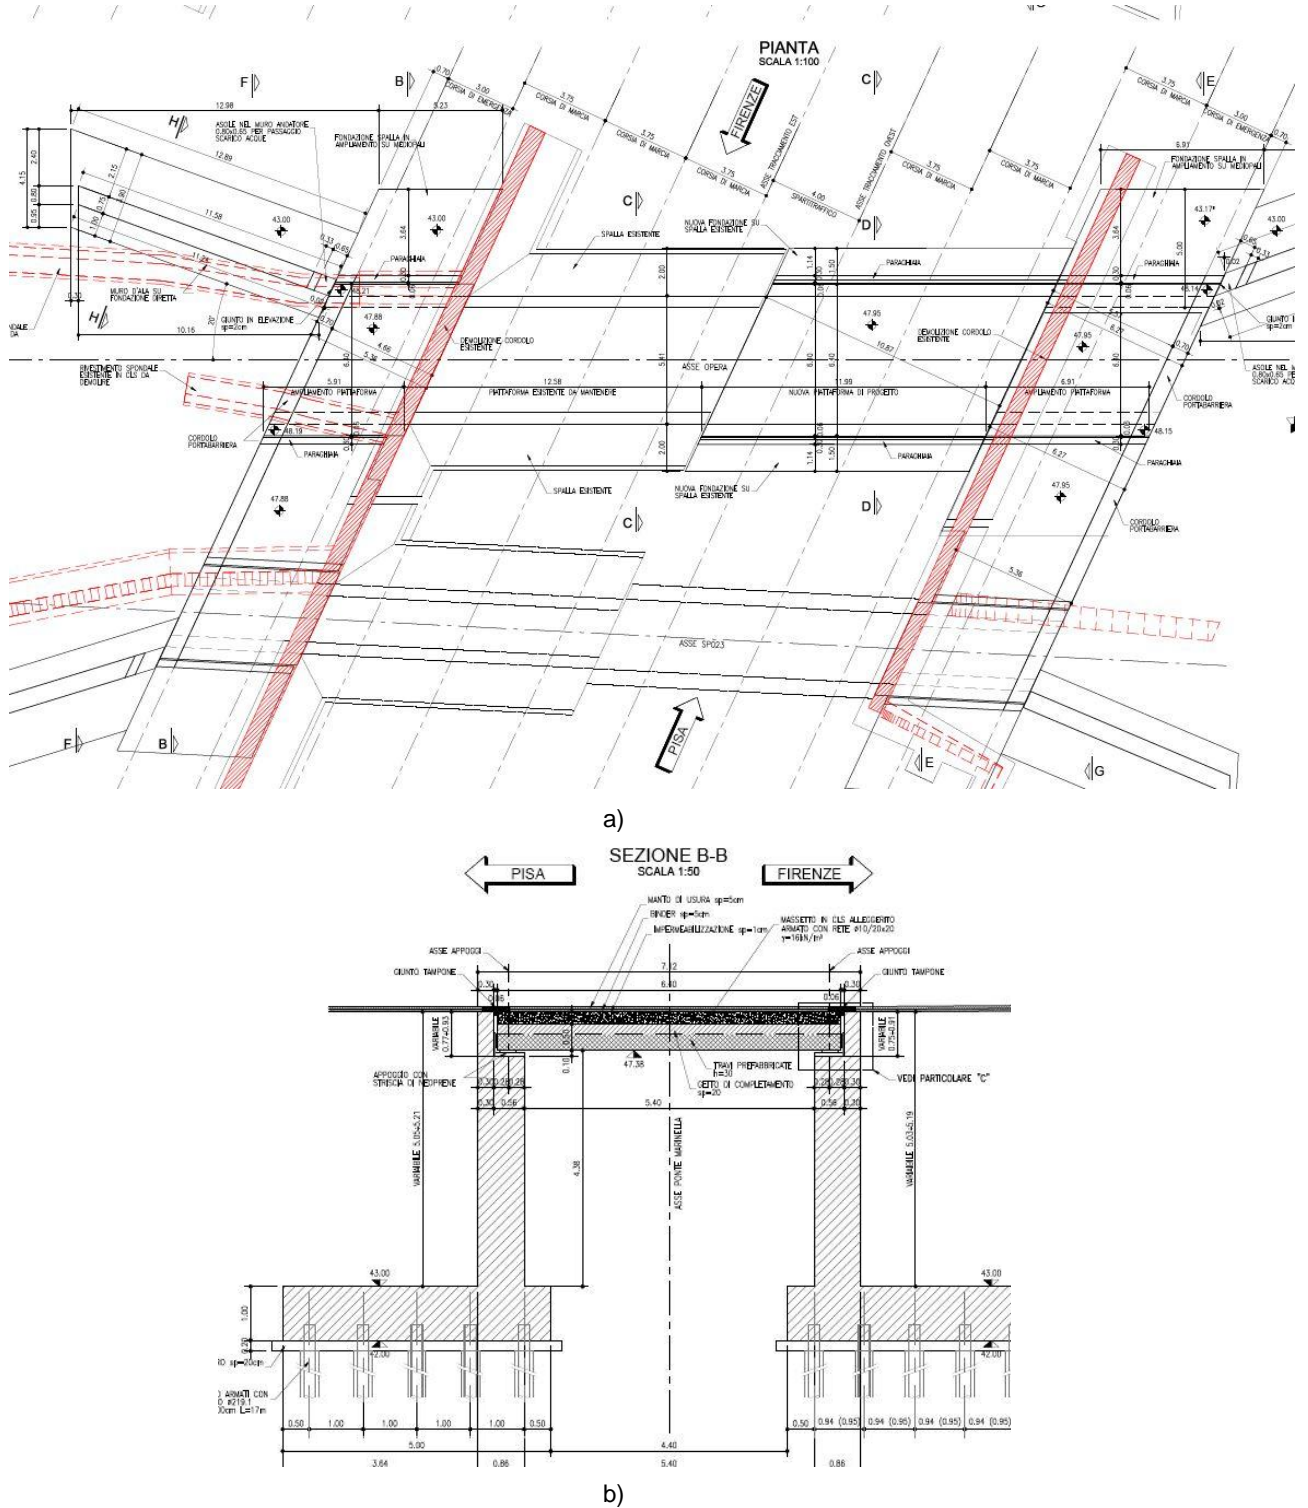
Ampliamento Ponte Marinella: stralcio planimetrico a); profilo longitudinale b).
